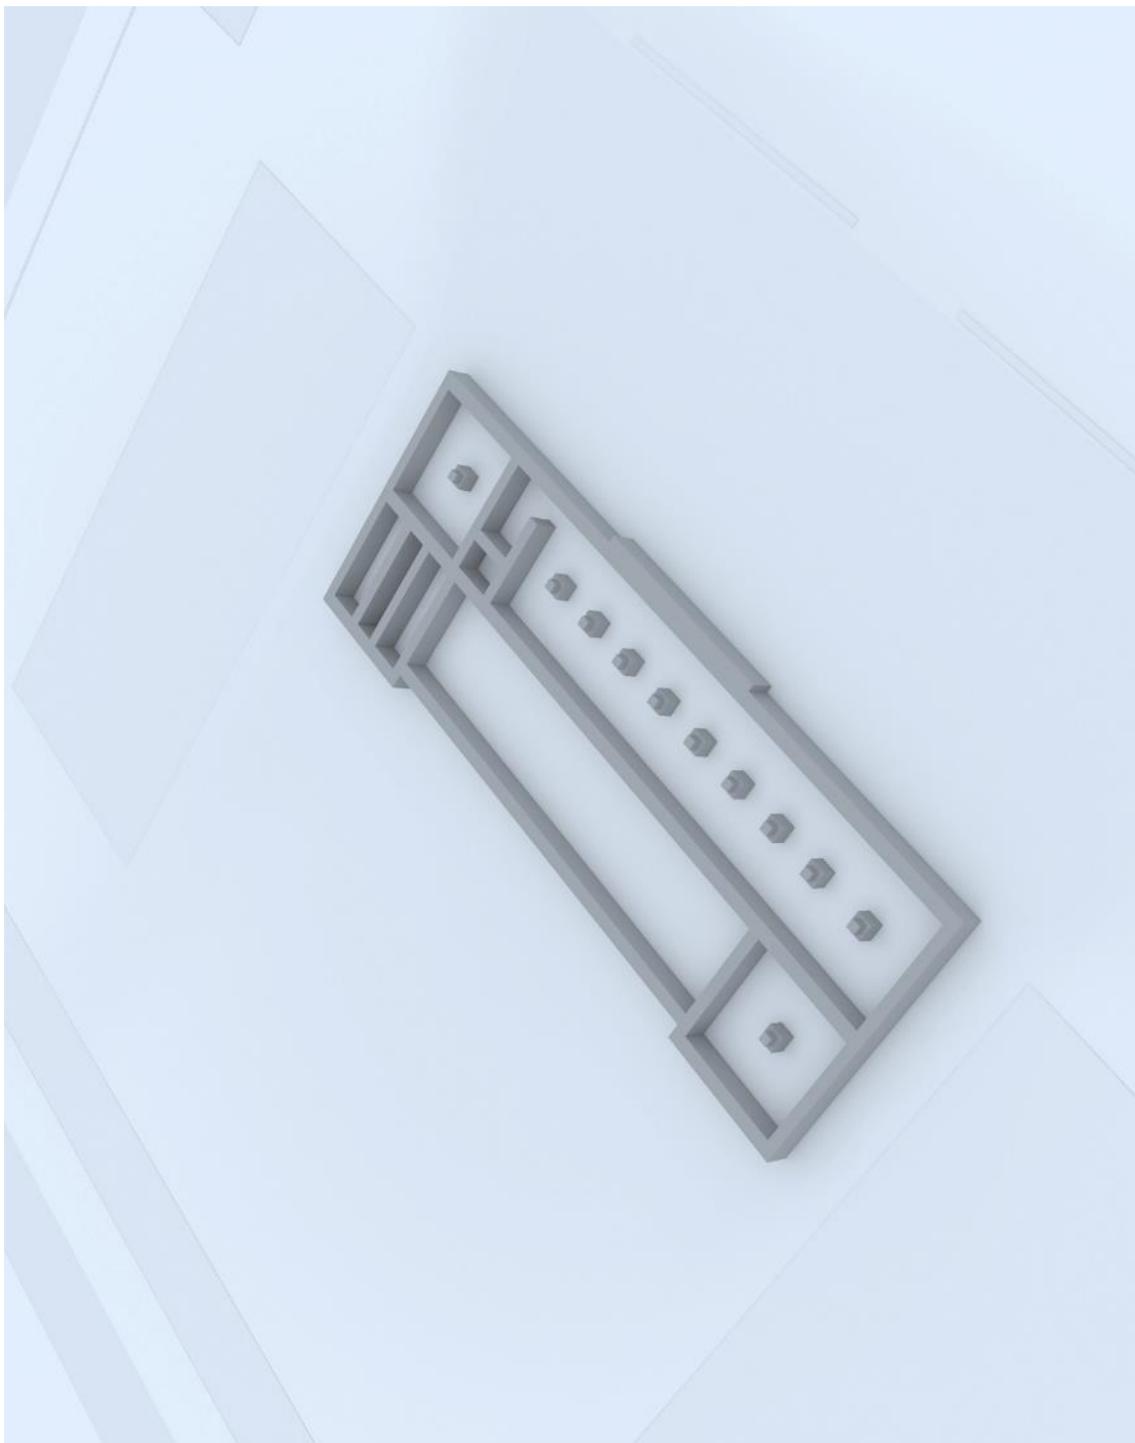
Imagen virtual. La fábrica. Planta de cimentación (se ha prescindido del terreno que envuelve la cimentación).
